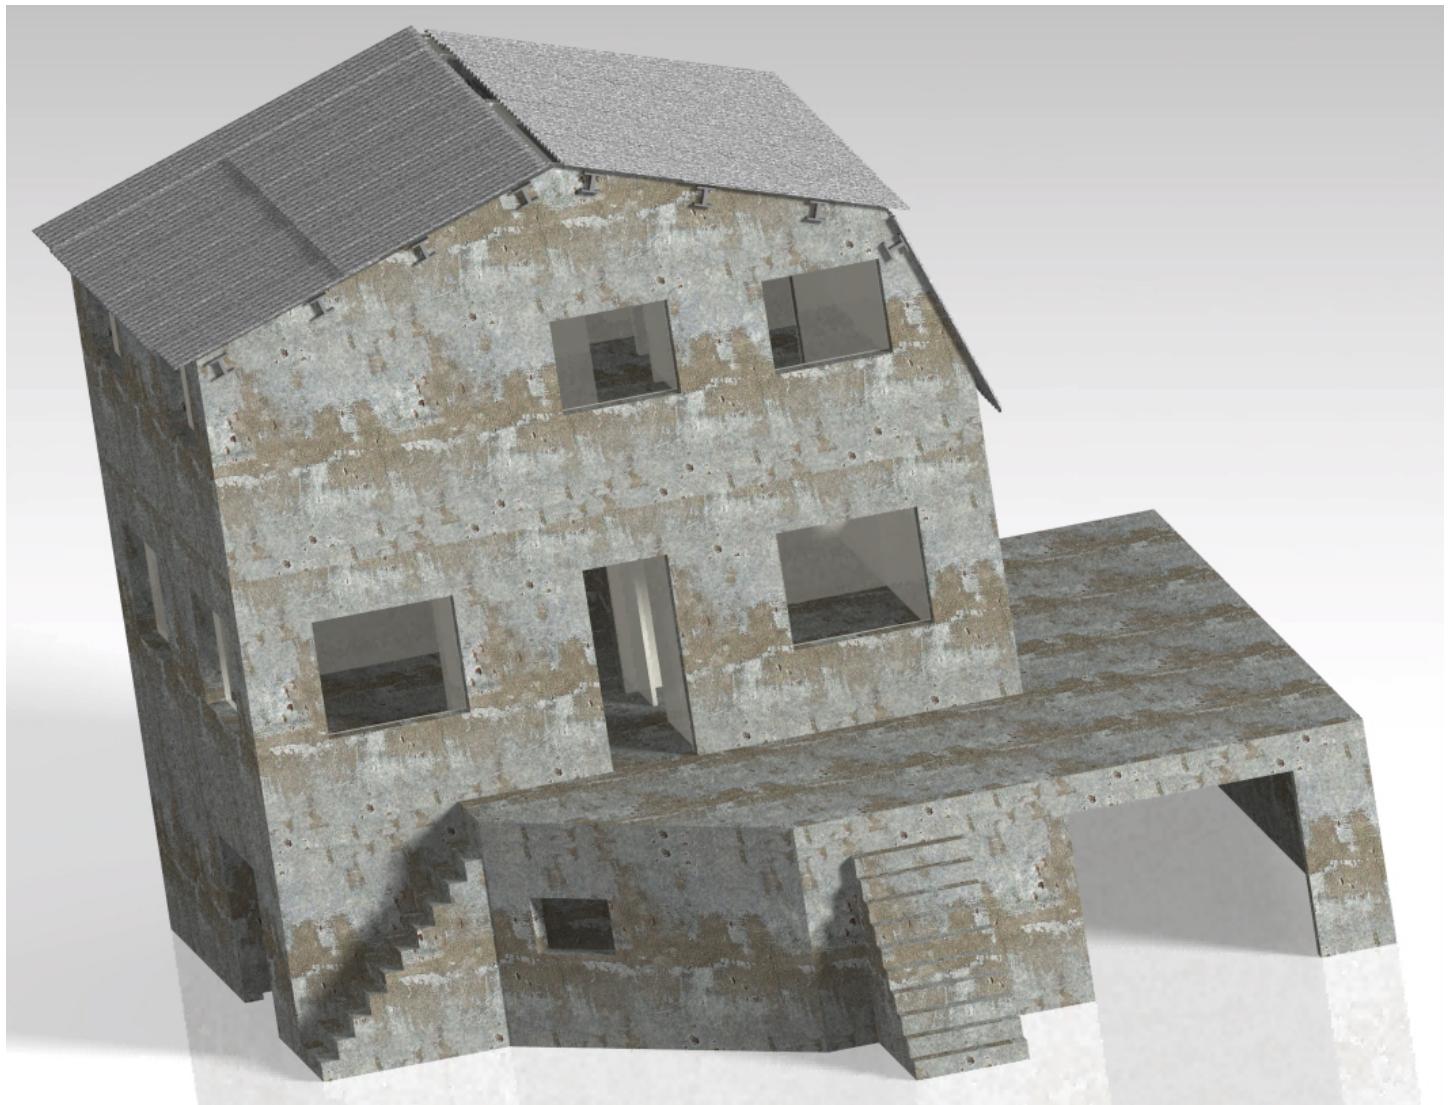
Avant : murs bruts béton banché + pierre meulière, couverture en fibrociment ondulé
